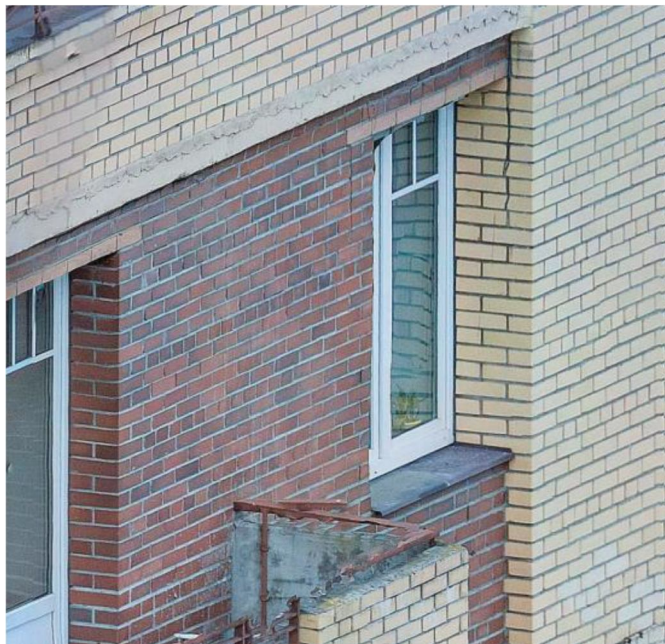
Фрагмент готового ортофотоплану фасаду під кутом. Видно вертикальну тріщину в простінку
